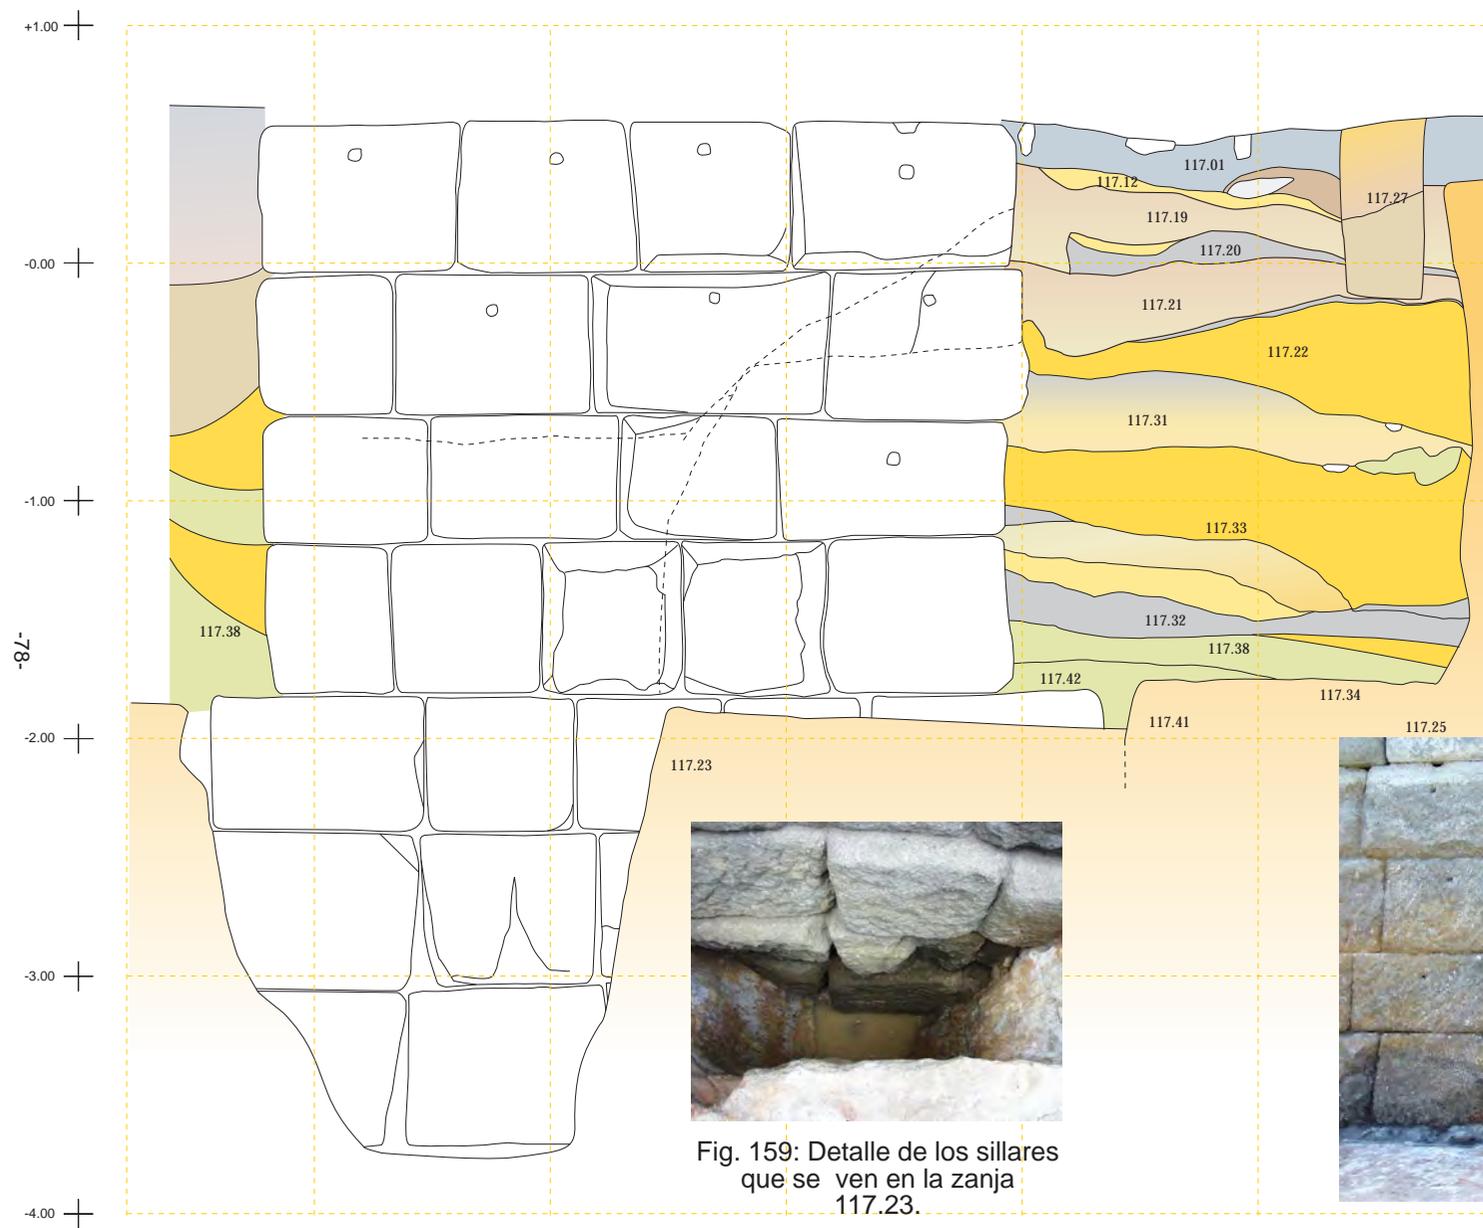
A-3. Perfil septentrional del sector 117 y alzado de la cara 4 de la pila 117.
